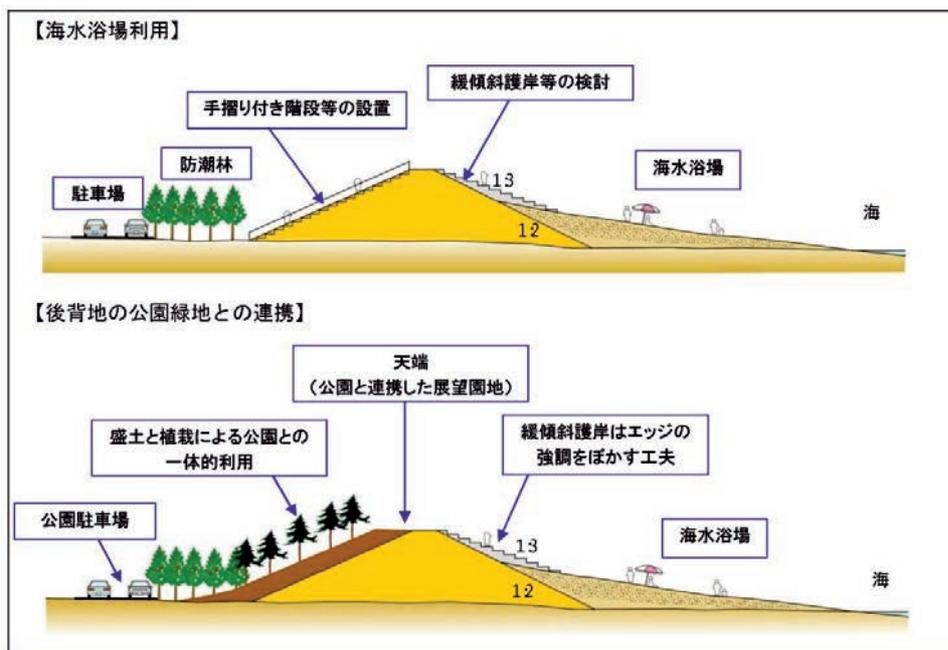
まちづくりと連携した堤防利活用断面図イメージ
